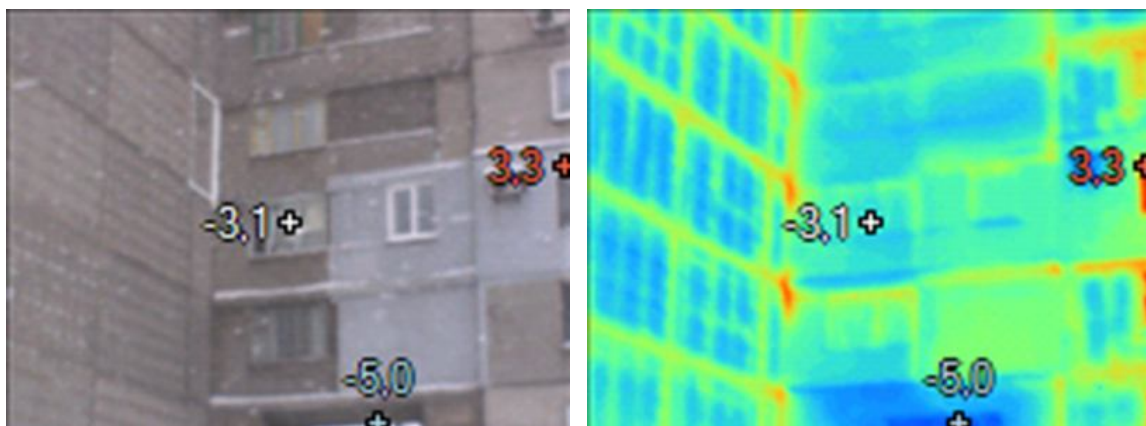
Некачественная теплоизоляция фасадной системы здания, а также теплопотери через стыки стеновых панелей
